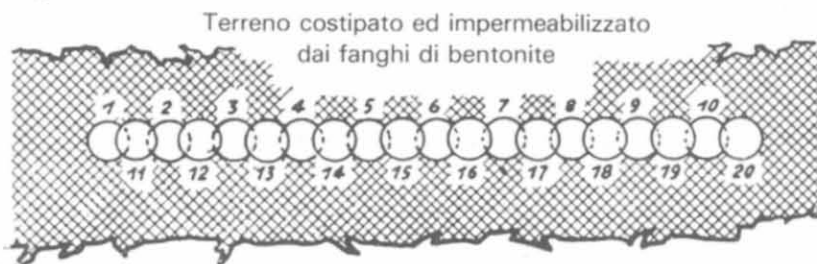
Schema di esecuzione del diaframma impermeabile brevettato dalla ICOS SpA di Milano, a elementi incastrati.
